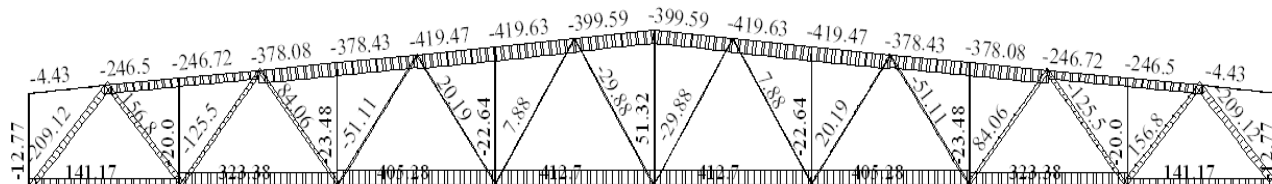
Усилия в стропильной ферме от постоянной и снеговой нагрузок
